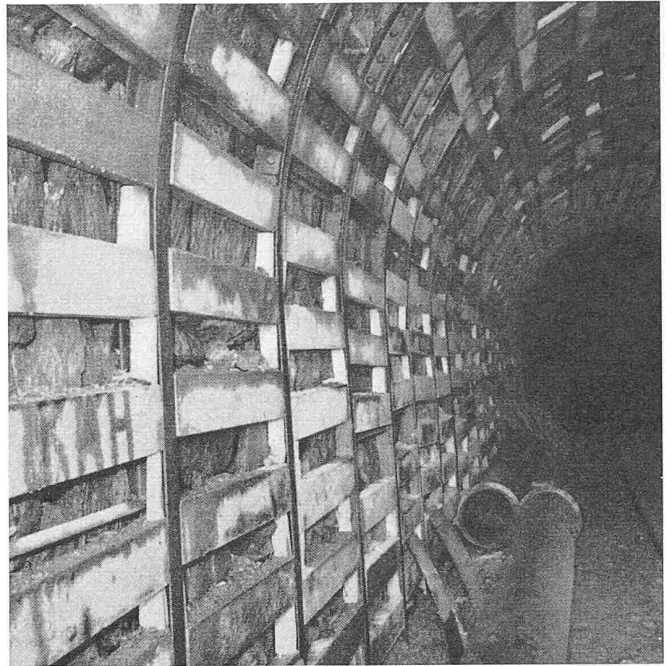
Stahleinbau in einem Zugangsstollen. Verzug mit eingeschobenen vorgespannten Betonbrettern und Steinhinterpackung (Kraftwerk Ackersand II)
